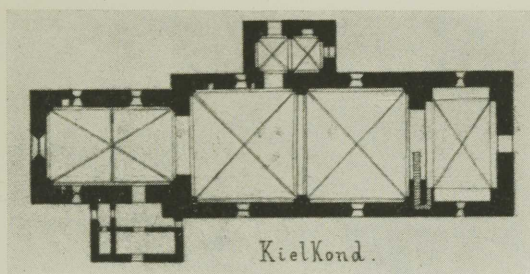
Grundriss der Kirche zu Kihelkonna.
